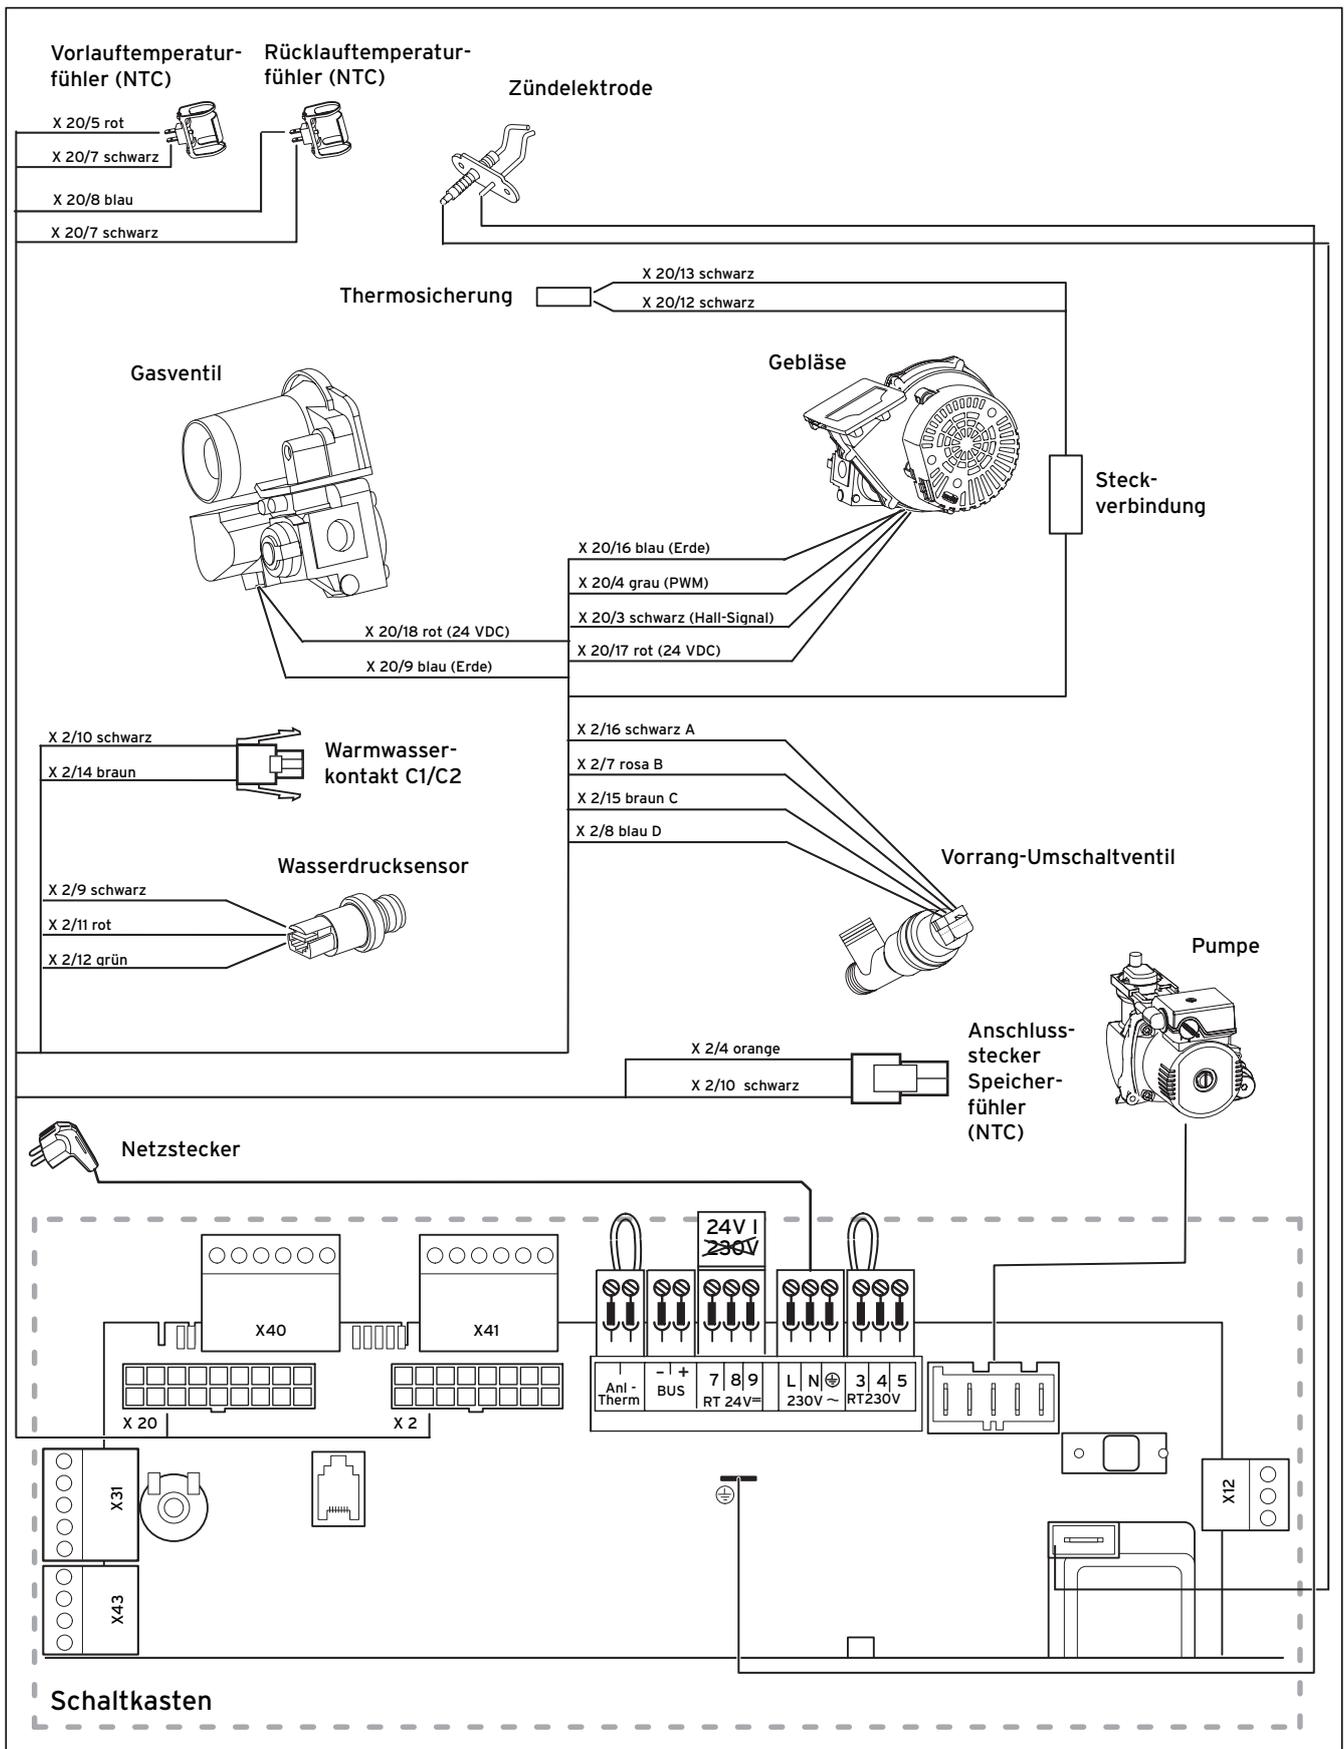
Verdrahtungsplan ecoTEC VC
